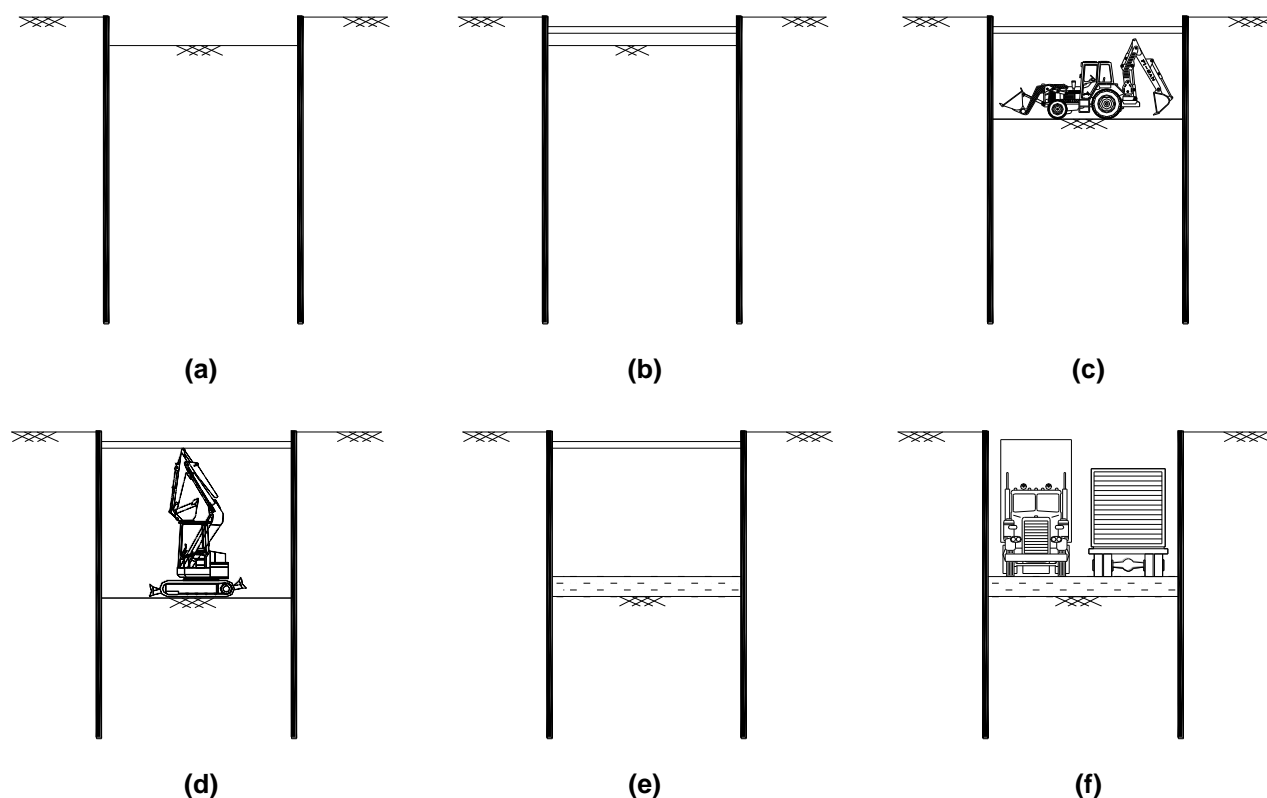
Faseamento construtivo de uma cortina autoportante com apoio superior em fase provisória: a) escavação até um pouco abaixo do nível da escora; b) colocação da escora; c) fase intermédia da escavação; d) escavação até à cota mais profunda; e) colocação do pavimento rígido; f) retirada da escora.
